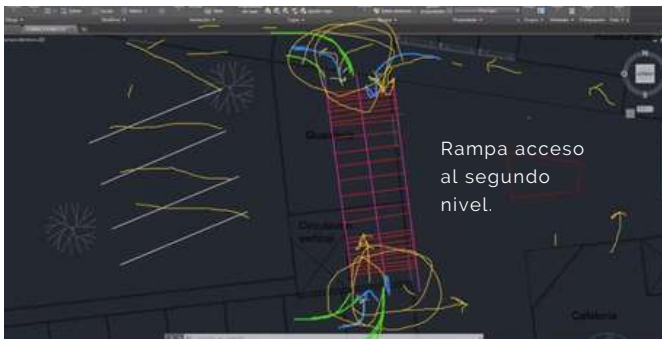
Planta arquitectónica con análisis de intenciones. Fuente: Autoría propia
